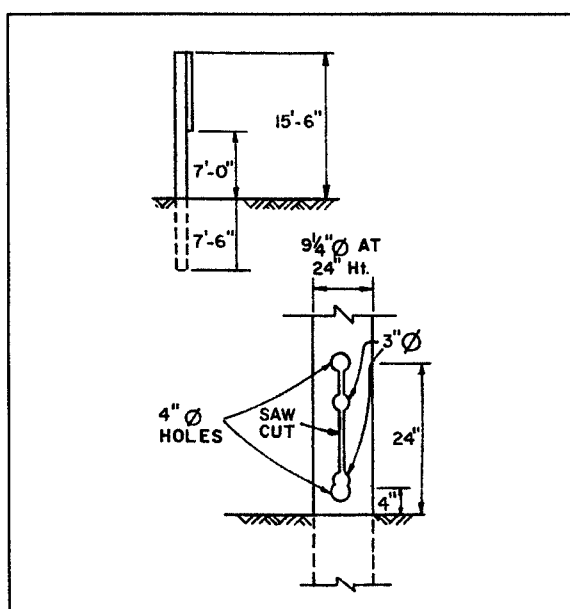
"Sollbruchbereich" einer Stütze aus Holz, \varnothing 235 mm [26]
